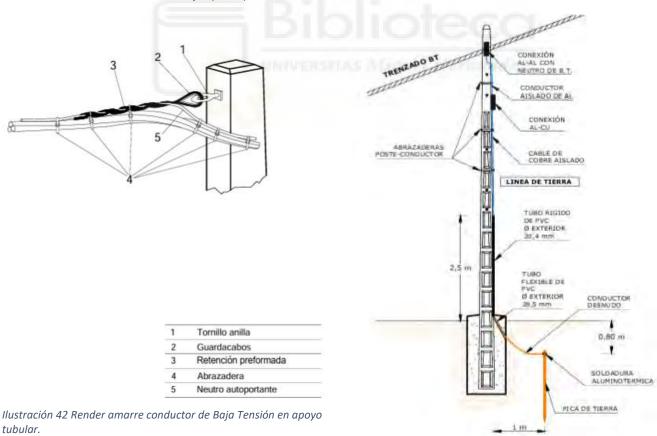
Ejemplo puesta a tierra en apoyo de Baja Tensión.
